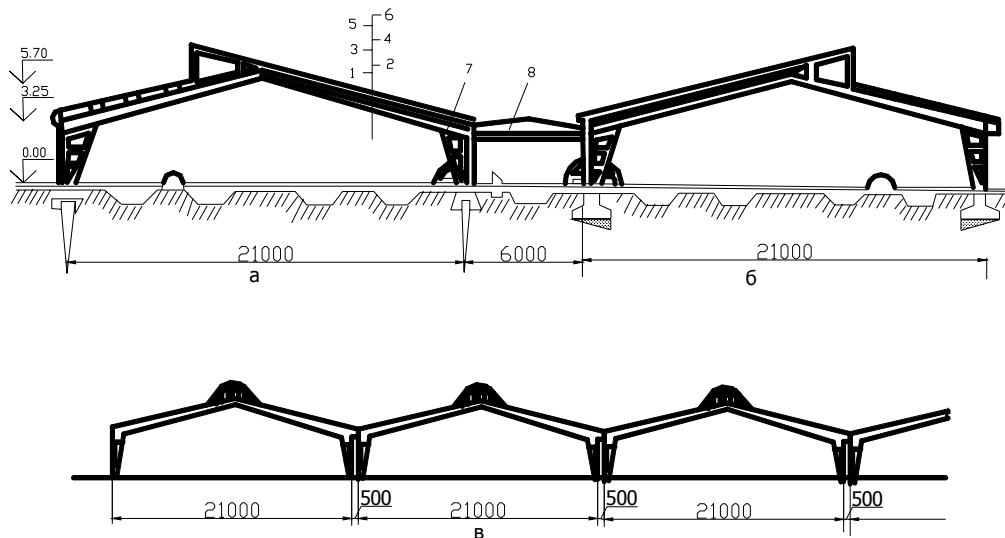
Поперечний переріз моноблоку в рамних конструкціях:
